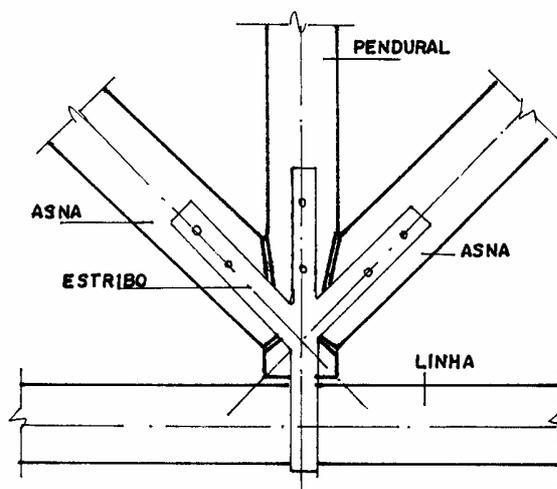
Ligações da linha com o pendural utilizando elemento de fixação metálico.
